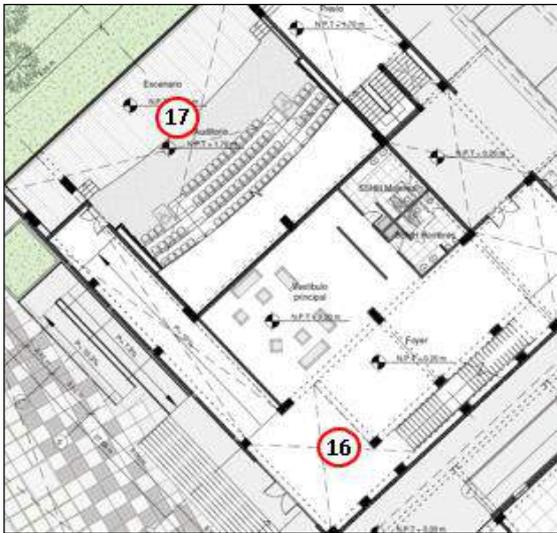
Planta Auditorio – nivel 1. Obstrucciones interiores
